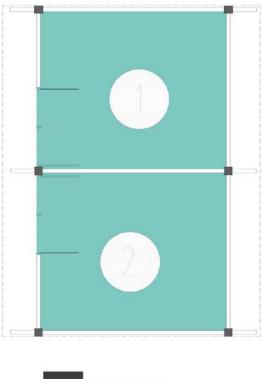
Planta 1 Bloque 35. Fuente: Equipo de diagnóstico.
